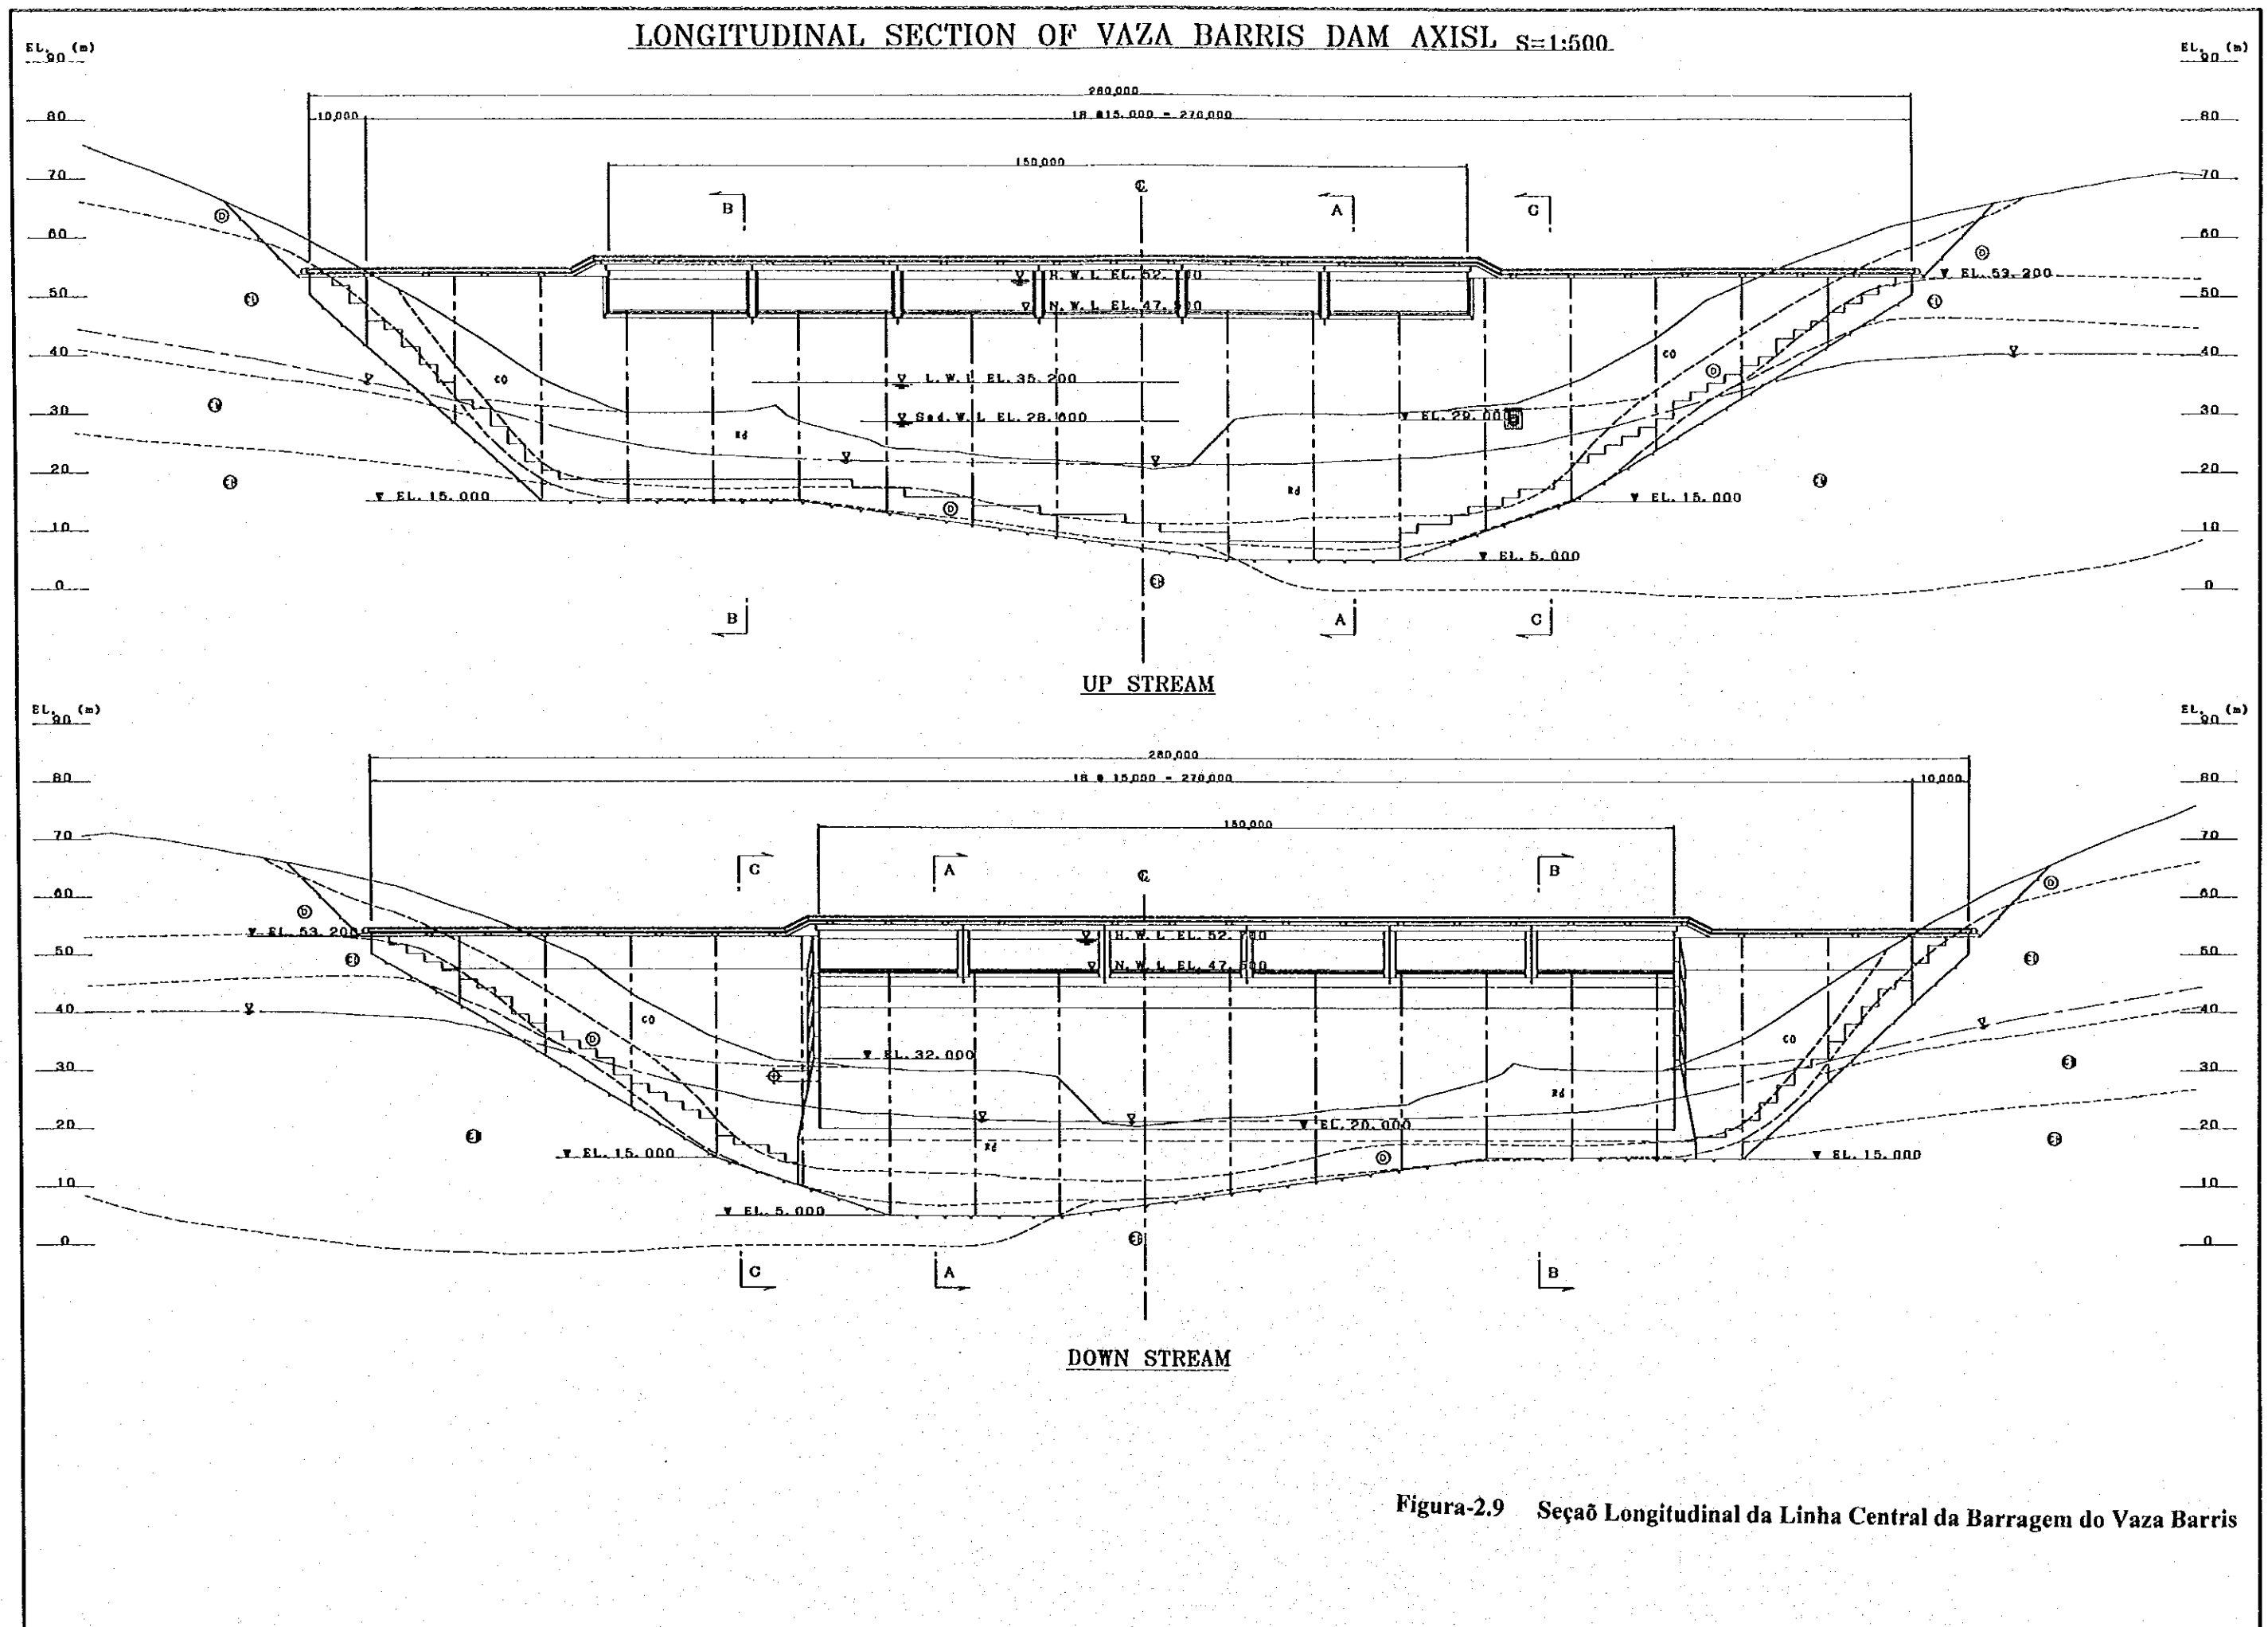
Seção Longitudinal da Linha Central da Barragem do Vaza Barris
